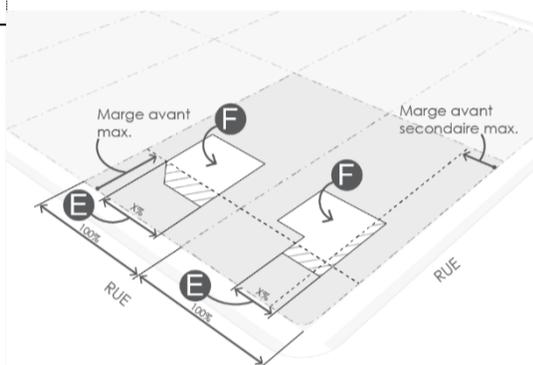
Front bâti et superficie d'implantation au sol d'un bâtiment
